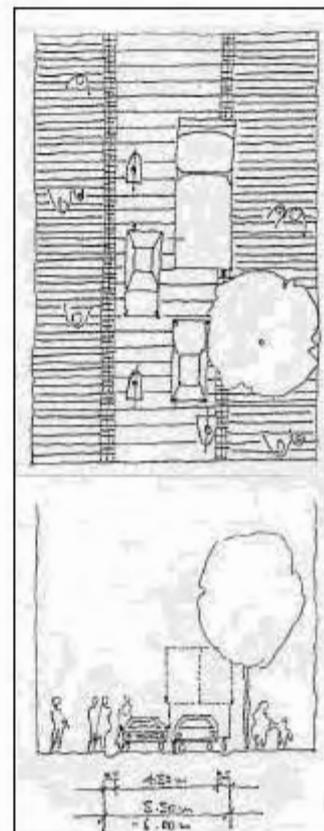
Straßenquerschnitt und Grundriss
